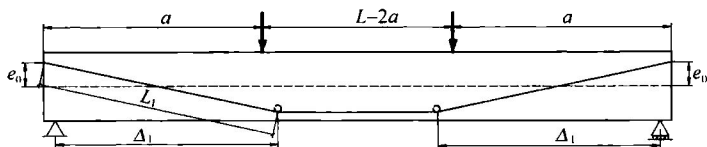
体外预应力 FRP 筋混凝土受弯构件示意
